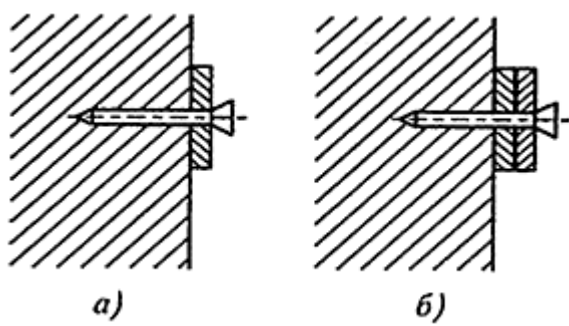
Крепление заземляющих проводников дюбелями непосредственно к стене (а) и с подкладкой (б)
